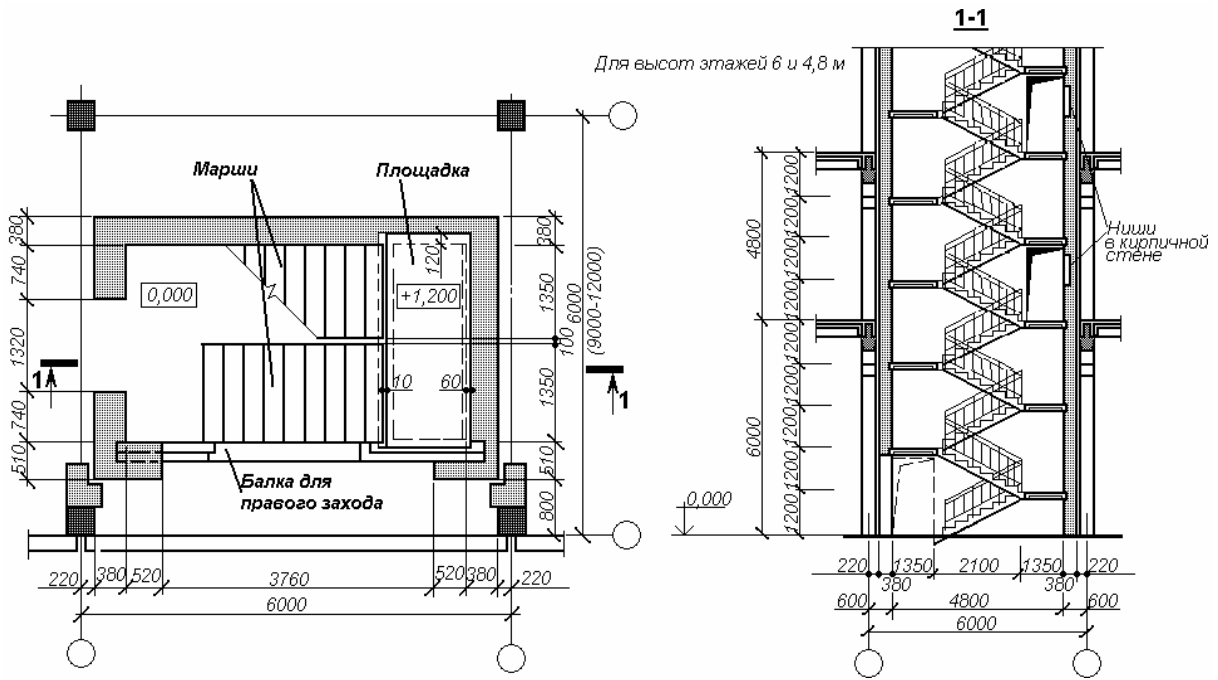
Пример решения лестничных клеток с кирпичными стенами.
